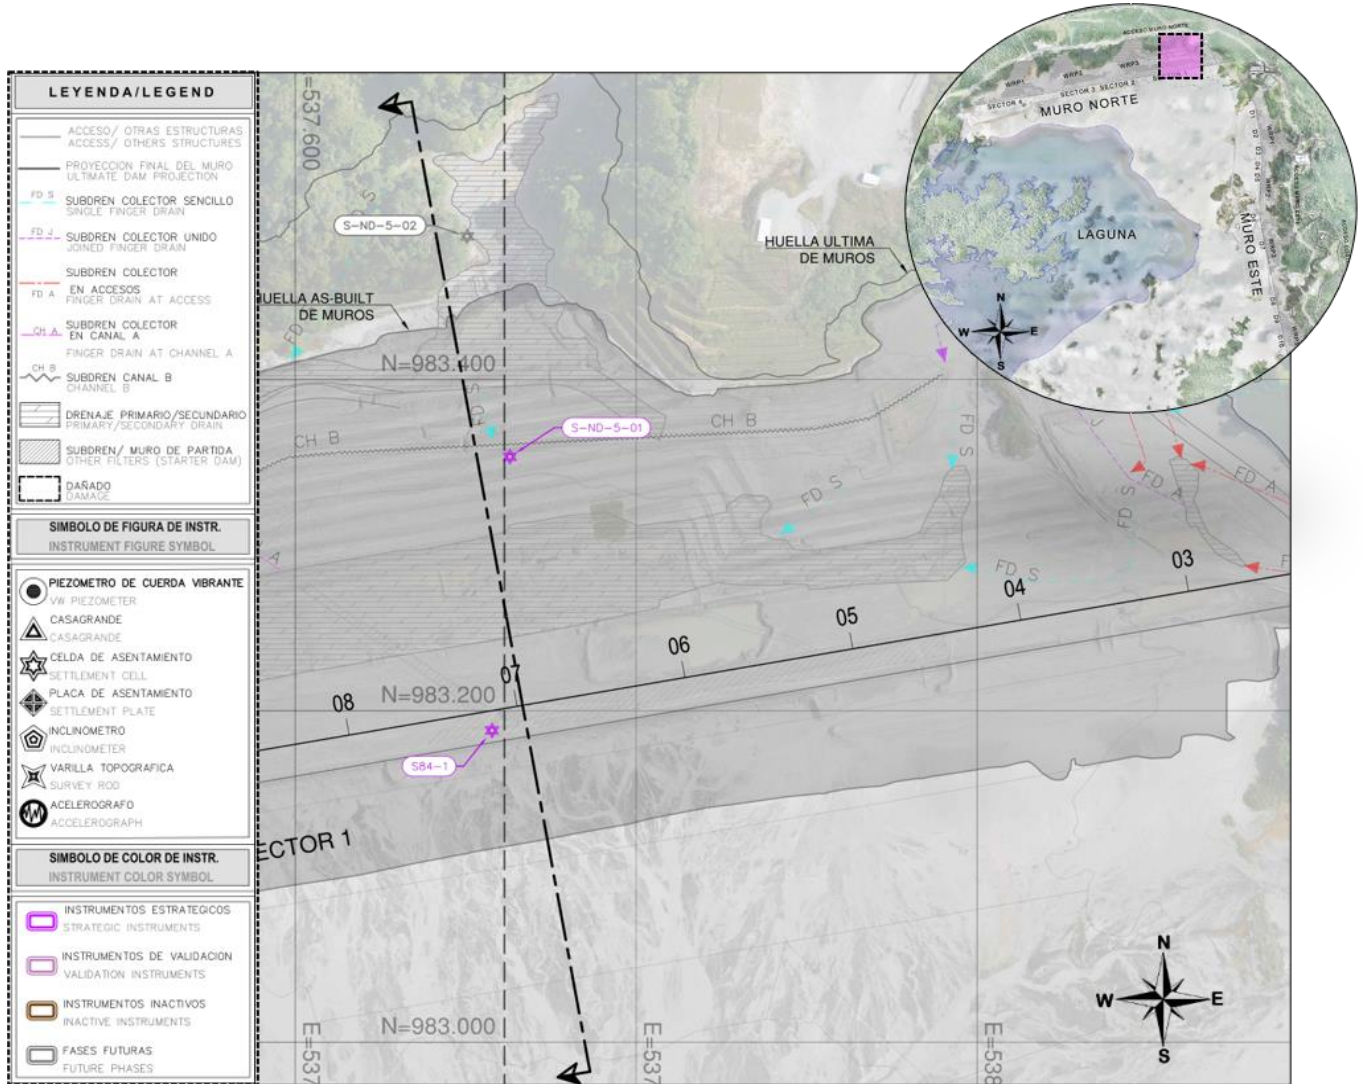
Vista de Planta en el Muro Norte Sector 1 con las Celdas de Asentamiento
